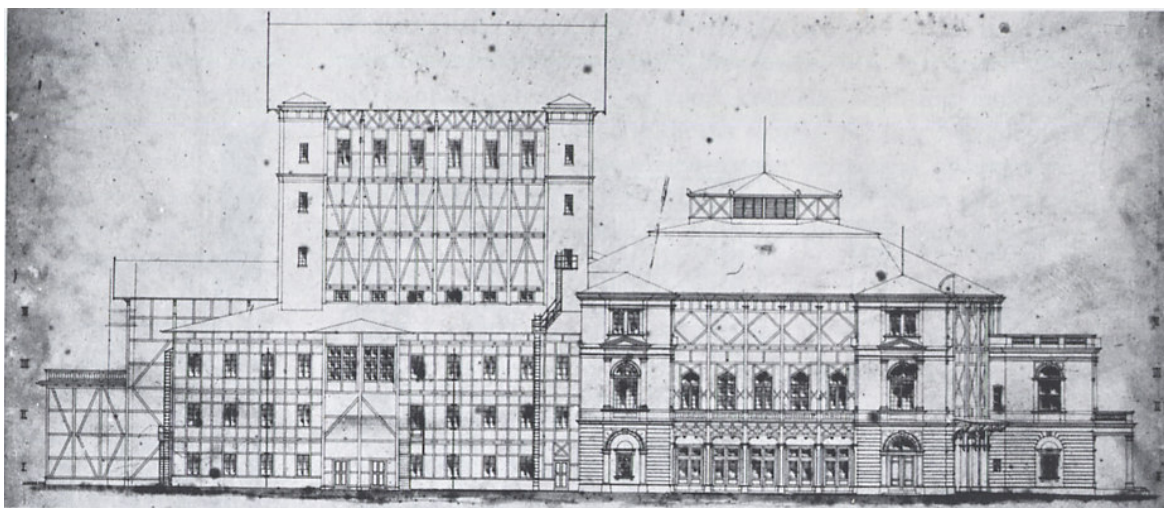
Prospetto esterno dell'edificio originario del Bayreuth Festspielhaus, da uno studio strutturale del 1914.
